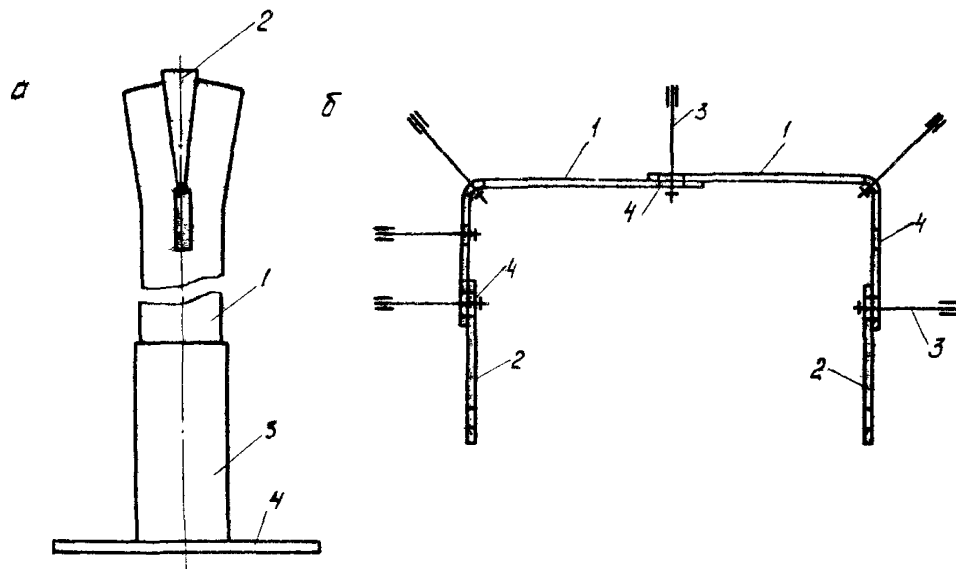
Конструкции анкерной крепи для крепления выработок, пройденных в устойчивом угольном массиве:
